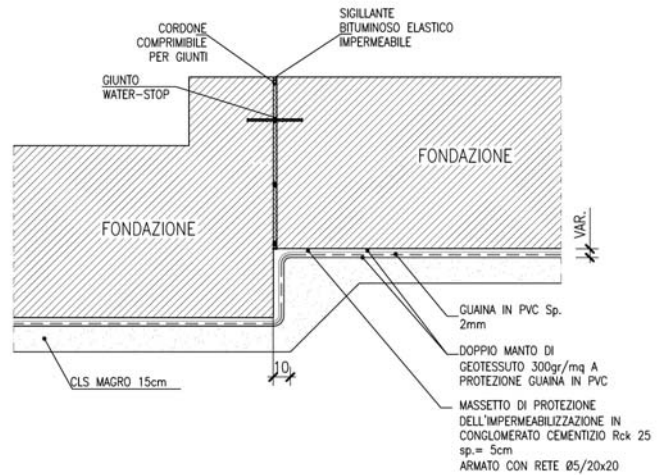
DETTAGLI IMPERMEABILIZZAZIONI.
